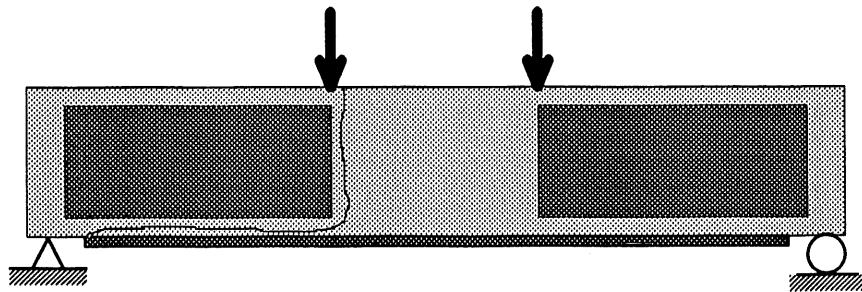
Collage de plaques sur les parois verticales de la poutre
